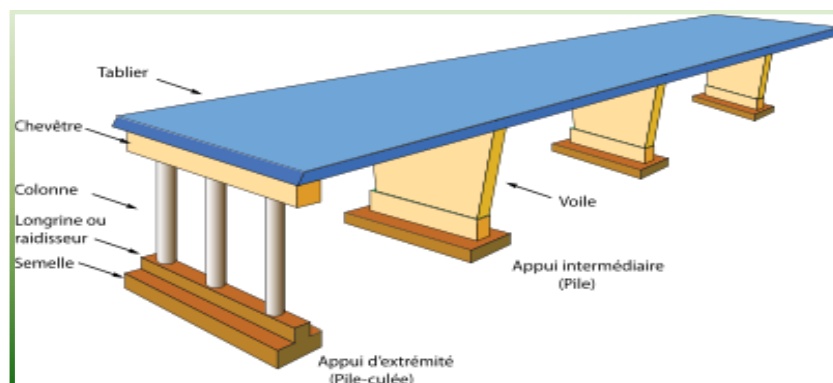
Structure pont pile-poutre à tablier intermédiaire.
